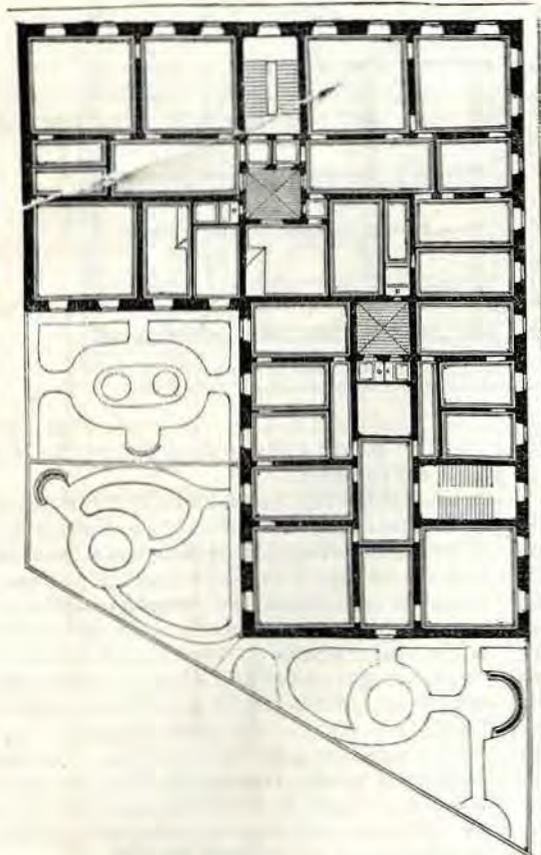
Isolato N° I, Casa da pignore. Pianta del primo piano. Scala di 1 : 420.
